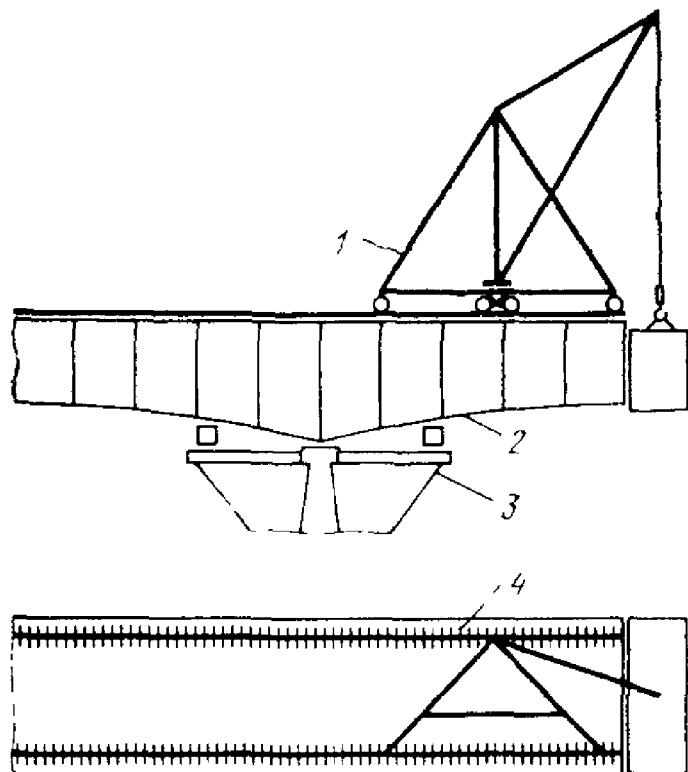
Схема установки деррик-крана при навесном монтаже железобетонного пролетного строения:
